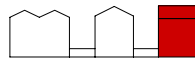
1/2-Zimmer-Wohnung 12
